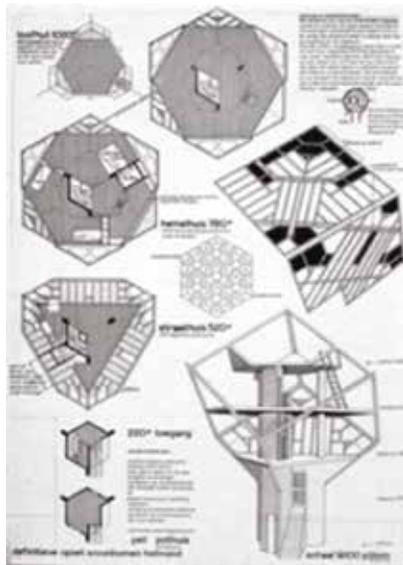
Planos de Casa Cubo. Fig. 8. Maqueta de Casa Cubo.
